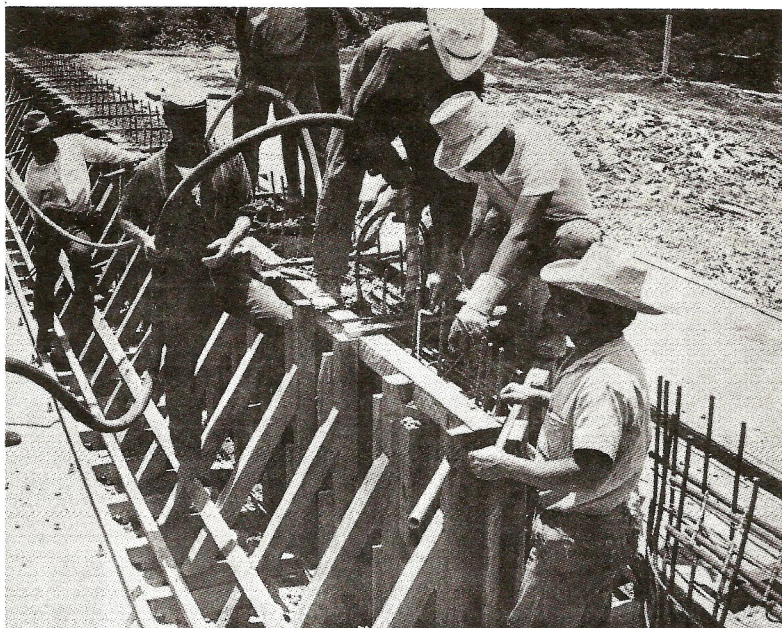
Fundiendo las vigas en suelo detrás de los estribos.
